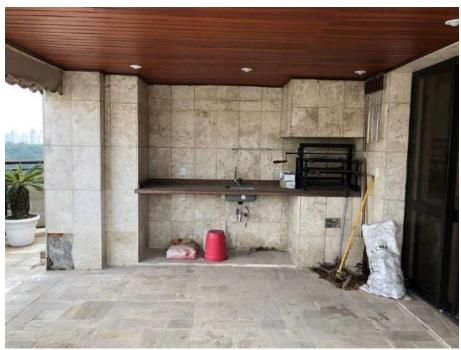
Vista parcial da varanda com área de pia e churrasqueira.
